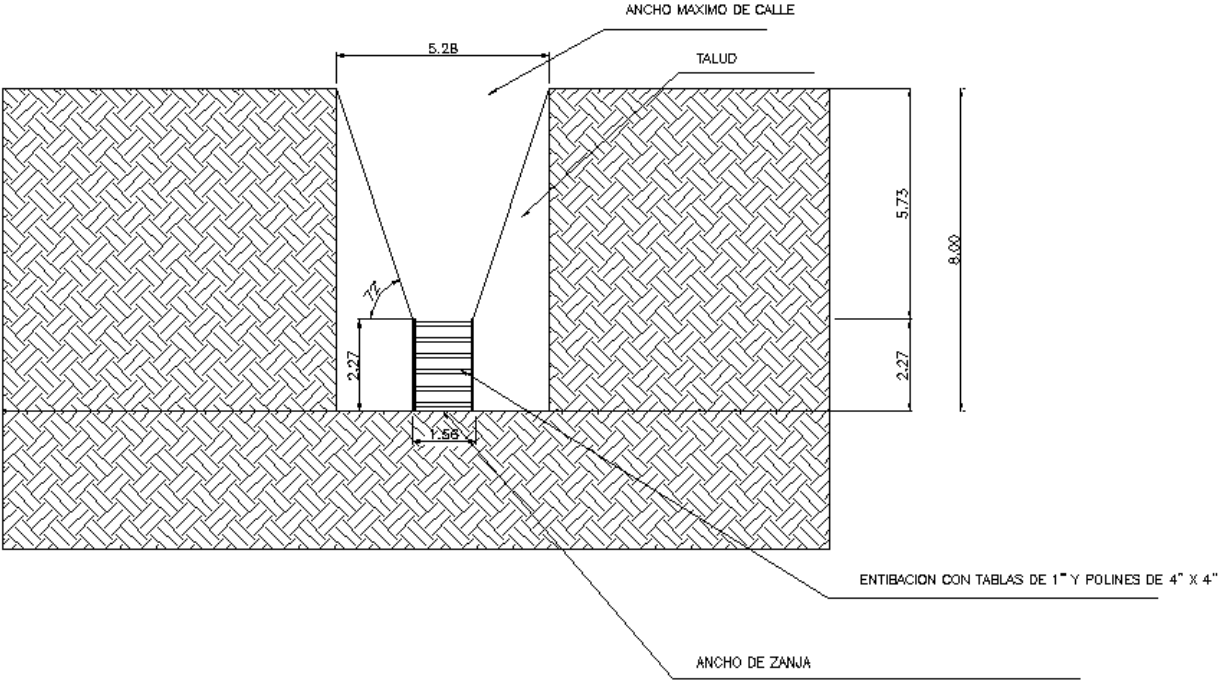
EXCAVACION PROFUNDA DE ZANJA
